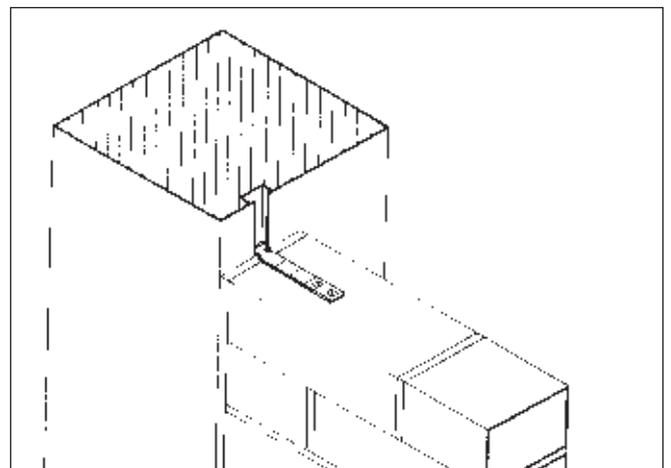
Elementi metallici di ancoraggio del paramento esterno al pilastro
